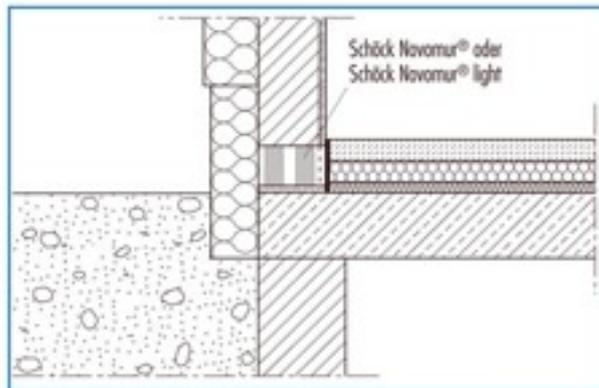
progettazione con isolam. con Schöck Novomur® o Schöck Novomur® light
